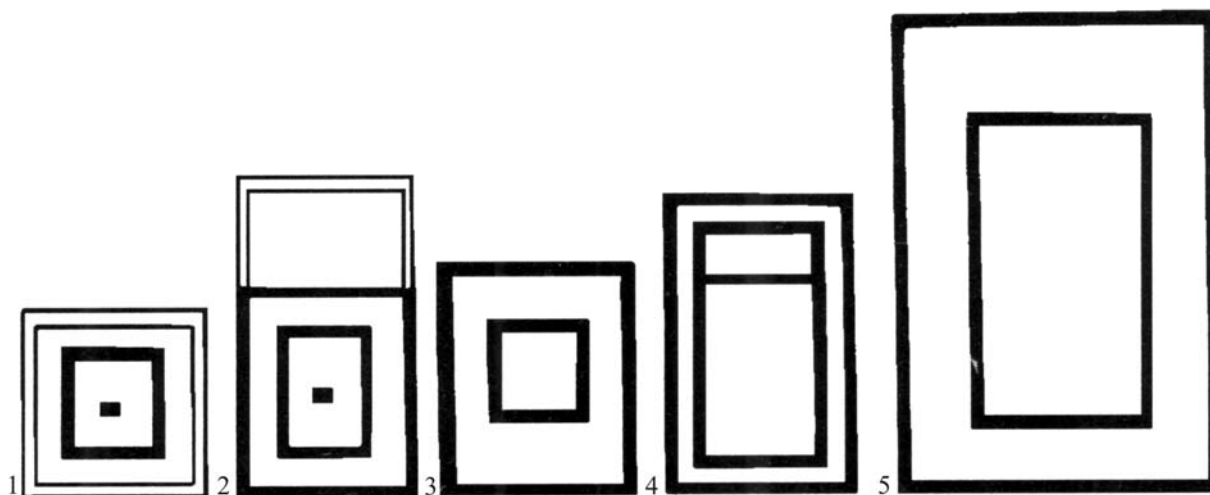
Grundrisse von angeblichen heidnischen Tempelbauten gemäß der 1983 publizierten Zusammenstellung von Dimităr Ovčarov (Orte alle im ehem. Bez. Šumen). 1 Preslav, äußere Stadt, ältere Bauphase der Kirche vor dem Südtor der inneren Stadt. 2 Pliska, innerer Palastbezirk. 3 Preslav, äußere Stadt am Ufer der Rumska reka. 4 Madara, Flur Daul taš. 5 Pliska, erste Bauphase der Hofkirche (alle Pläne mit vielen Ungenauigkeiten!; nach Aladžov 1999, S. 12 Abb. 11).
